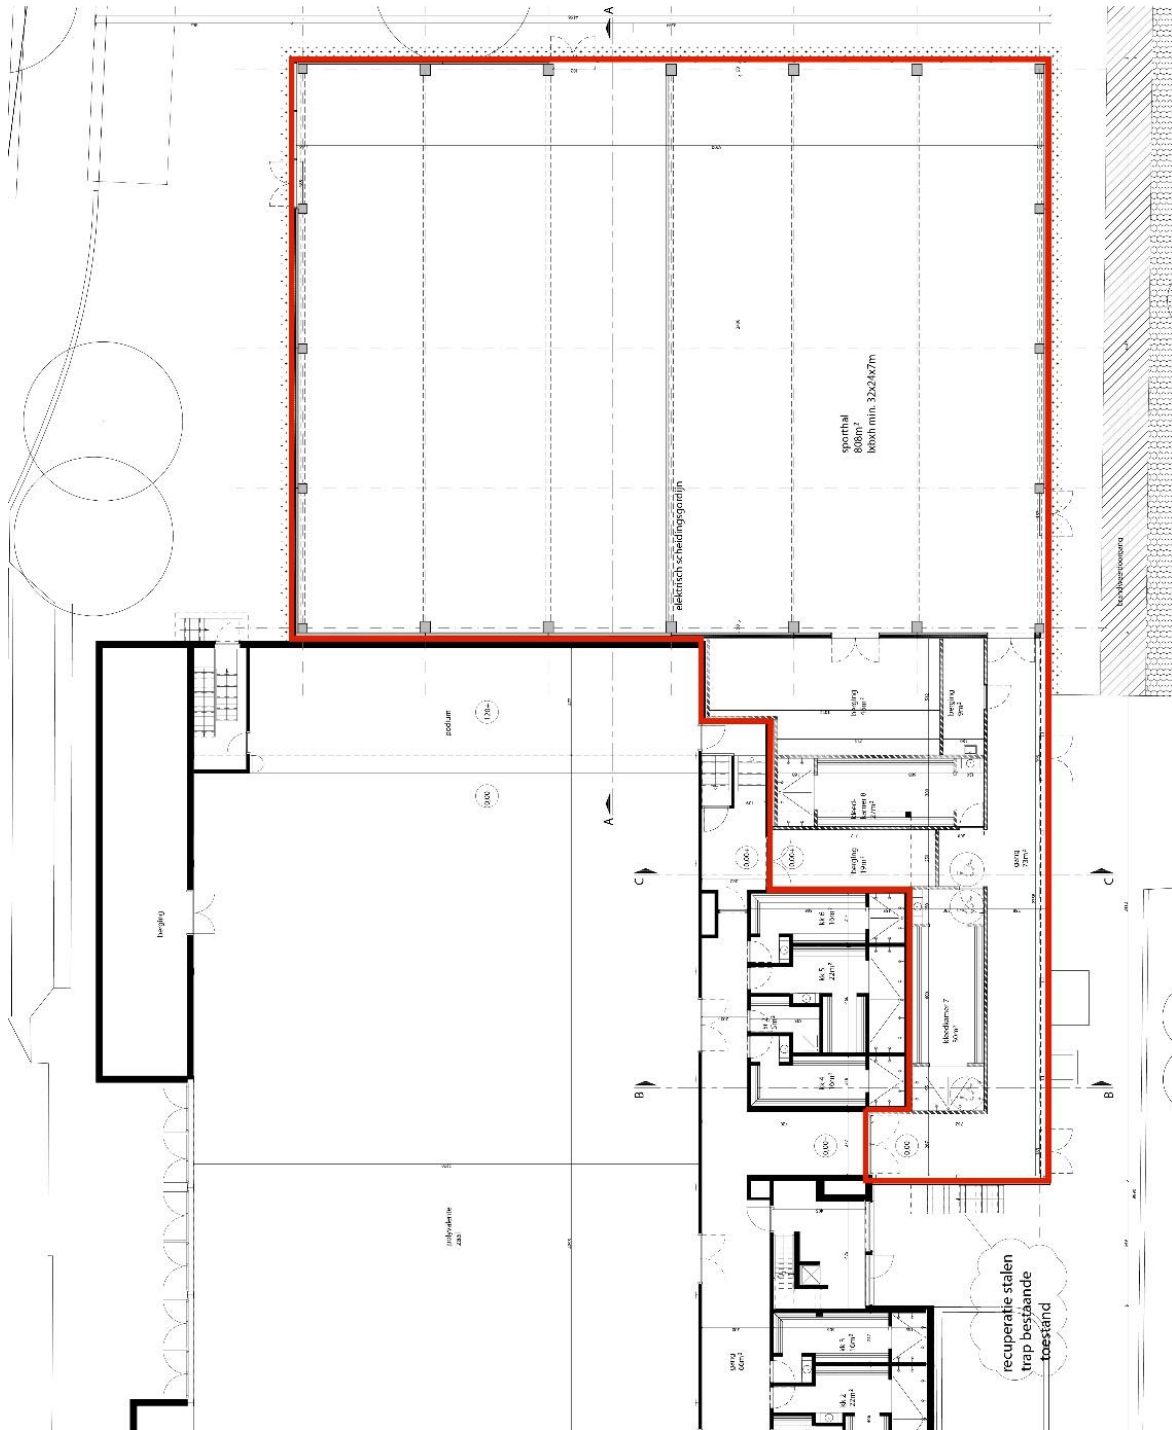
Plangebied met weergave van grondplan van geplande toestand⁵
